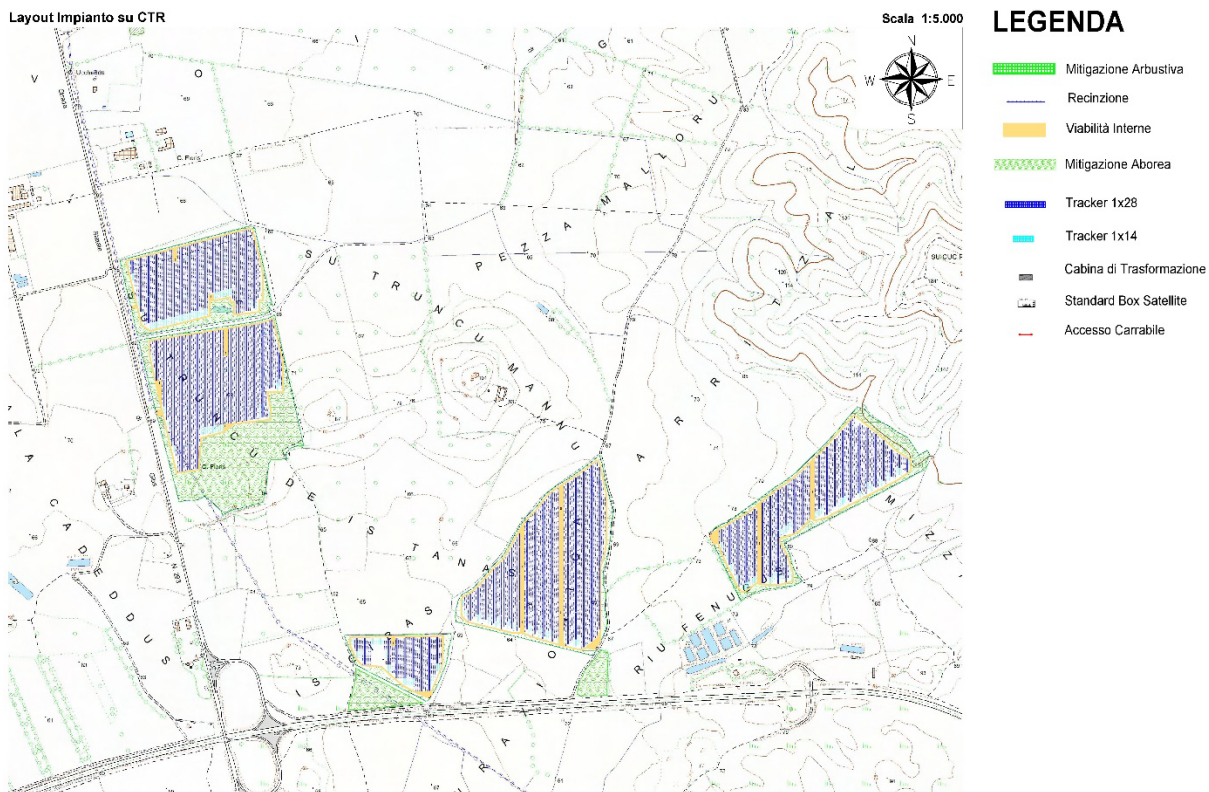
Layout del futuro impianto FV_ SILQUA su C.T.R.
